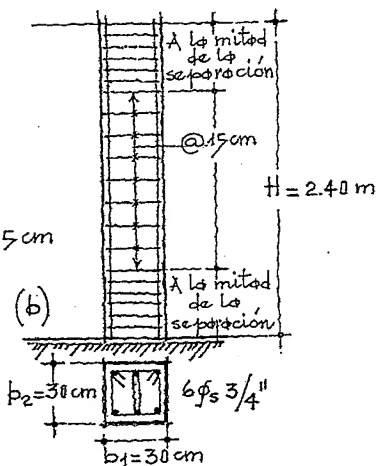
Colocación del acero vertical y separación de estribos en la columna, (b).
